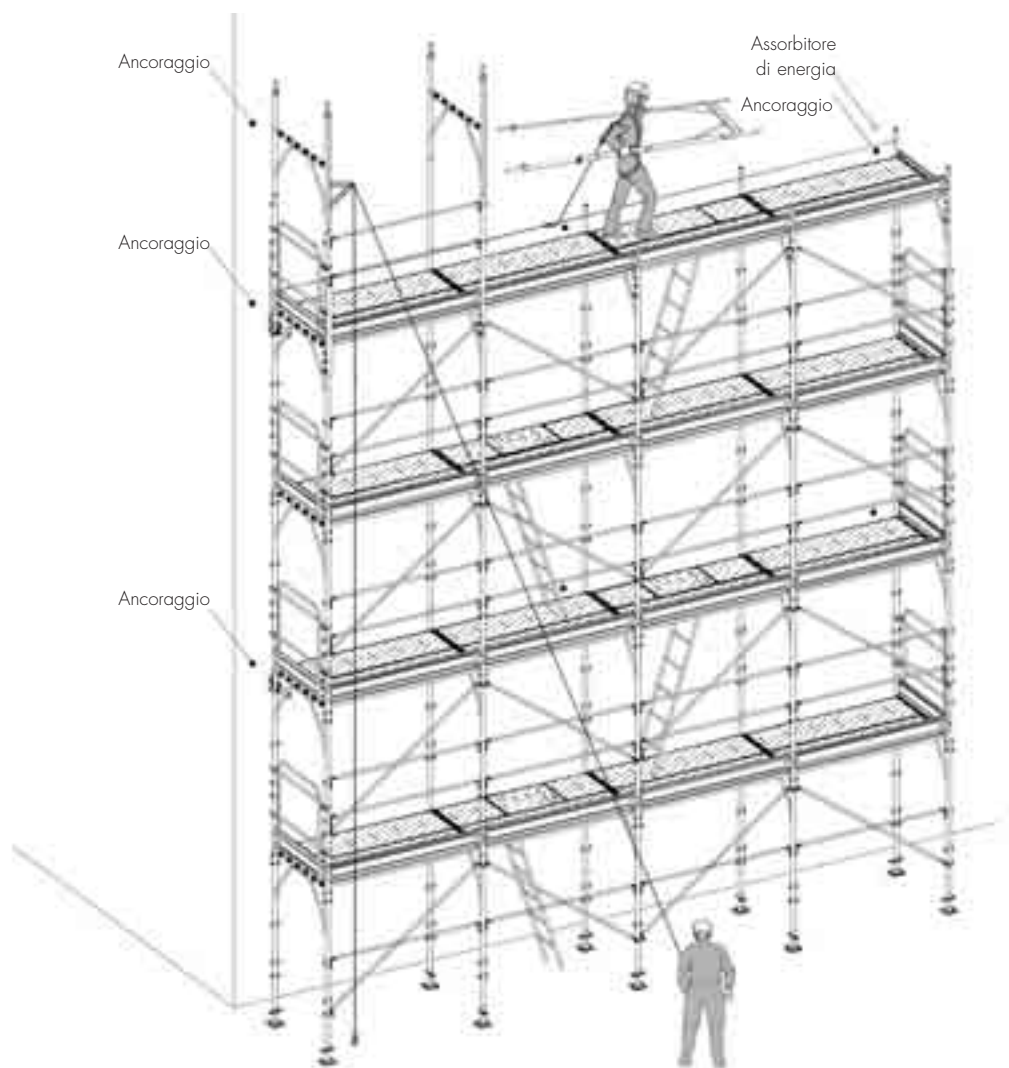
Esempio di montaggio con argano di sollevamento al piano di assemblaggio
